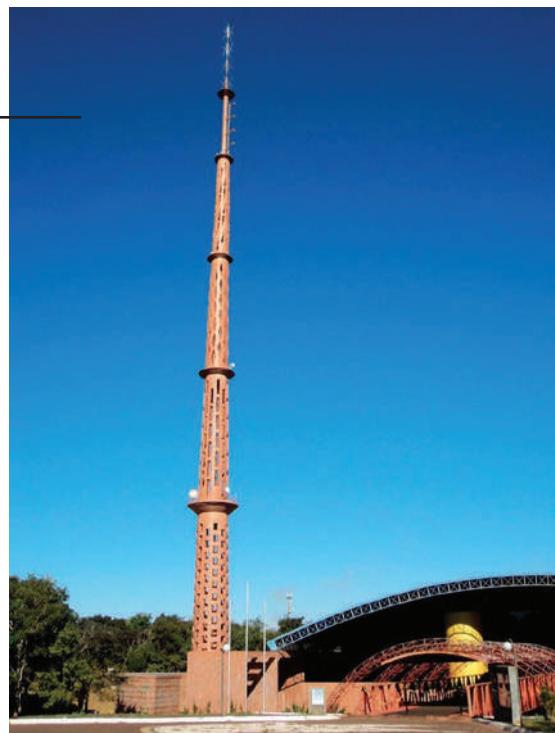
Vista da torre da TV Educativa em Campo Grande – MS, com 100 m. de altura. Construída com tijolo de 21 furos, sem andaimes exteriores e sem grua, toda em cerâmica armada. (*-12).
